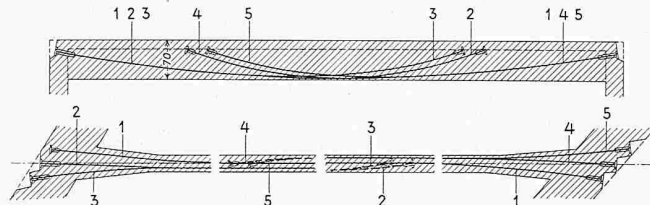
Schema der Kabelführung im Längsschnitt und im Grundriss
